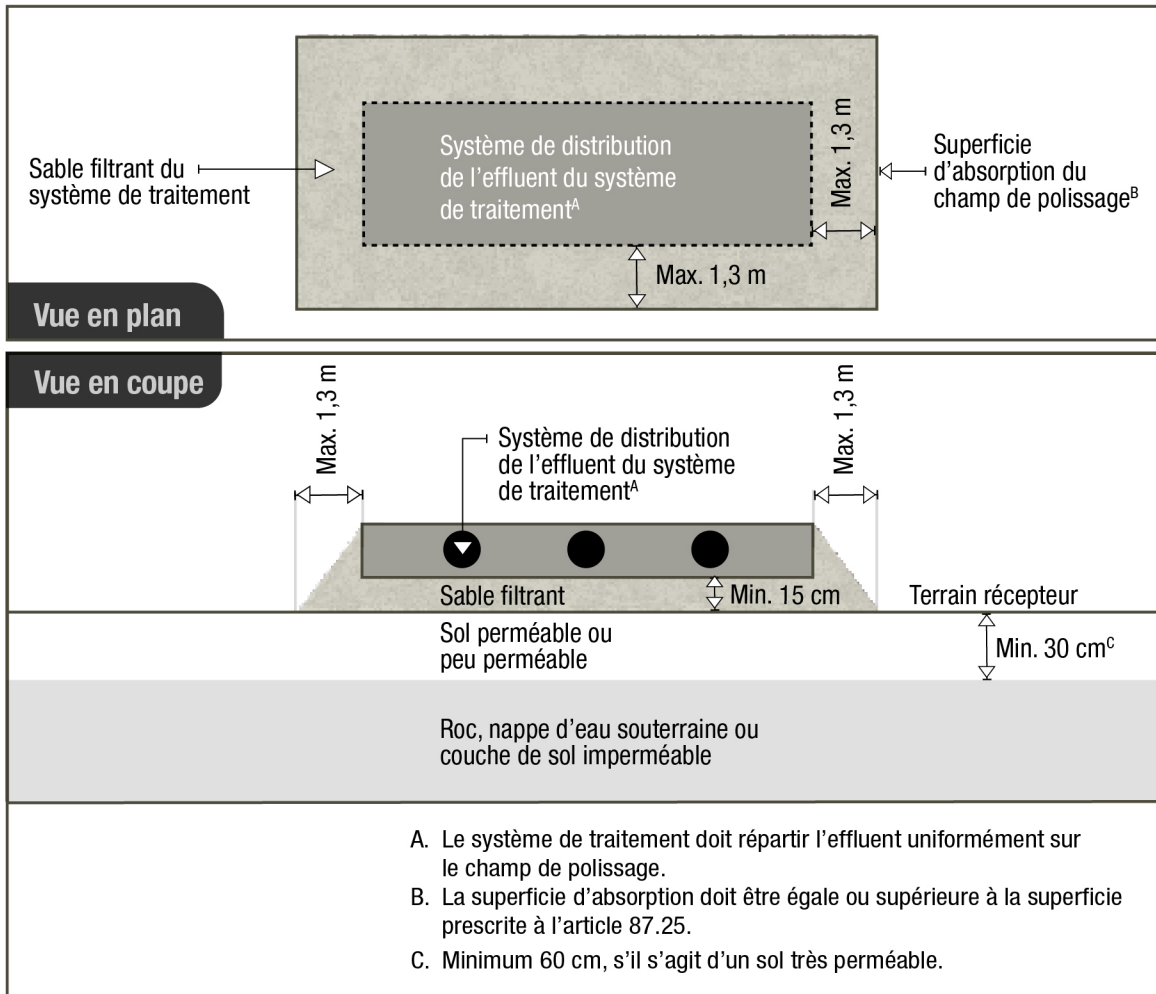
Système certifié NQ 3680-910 construit sur place ne couvrant pas toute la superficie d'absorption du champ de polissage
